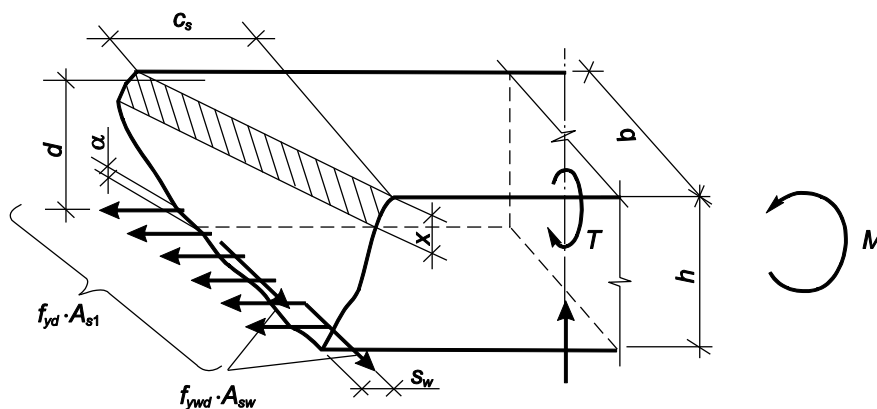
Схема усилий в пространственном сечении железобетонного элемента, работающего на кручение с изгибом, при расчете его по прочности
